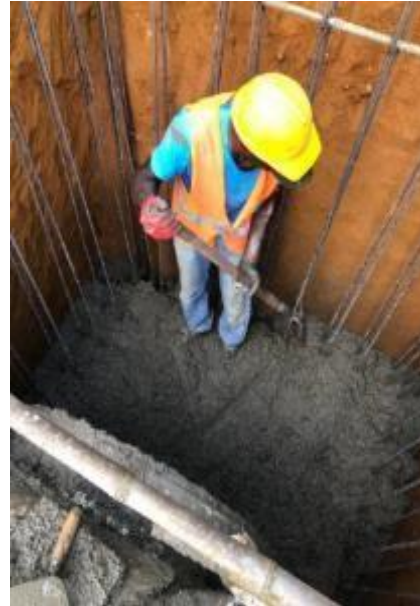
Relleno y compactación tierra amarilla del alcantarillado. Barrio Obrero.
